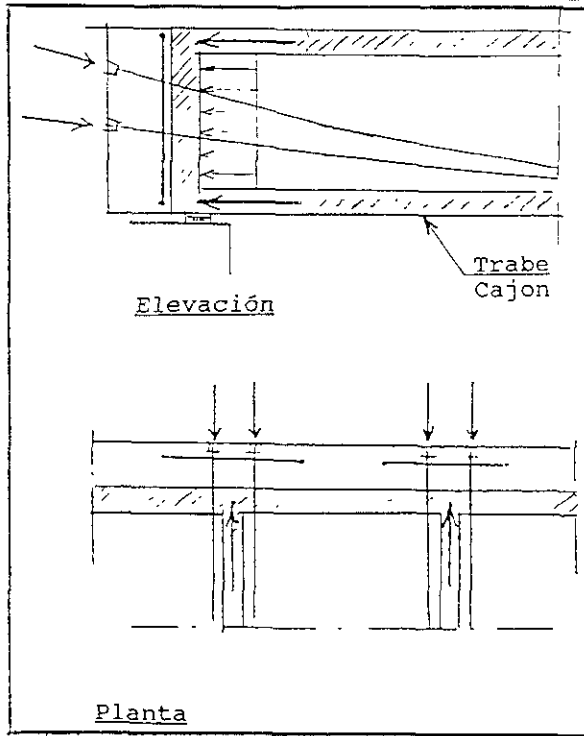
Presfuerzo adicional; Bloque de anclaje.
